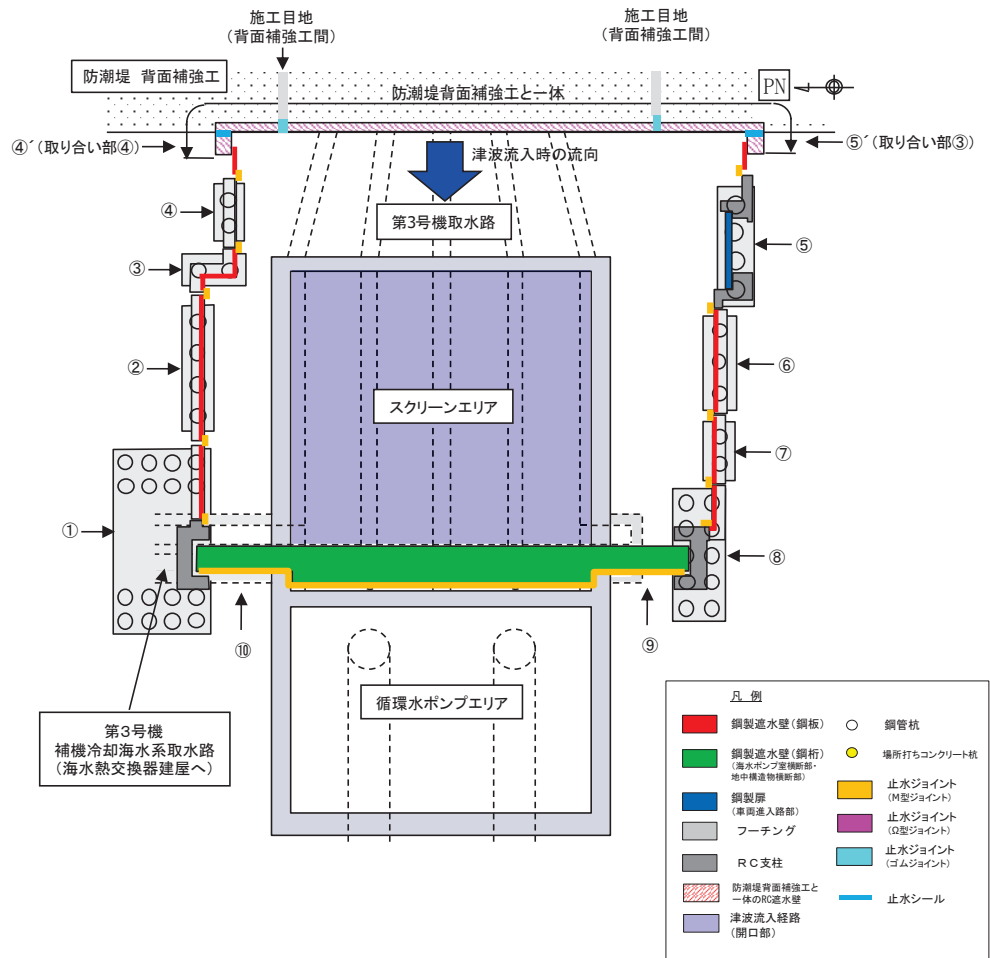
(1) ボイリング評価検討箇所平面図 (防潮壁 (第 3 号機海水ポンプ室))
